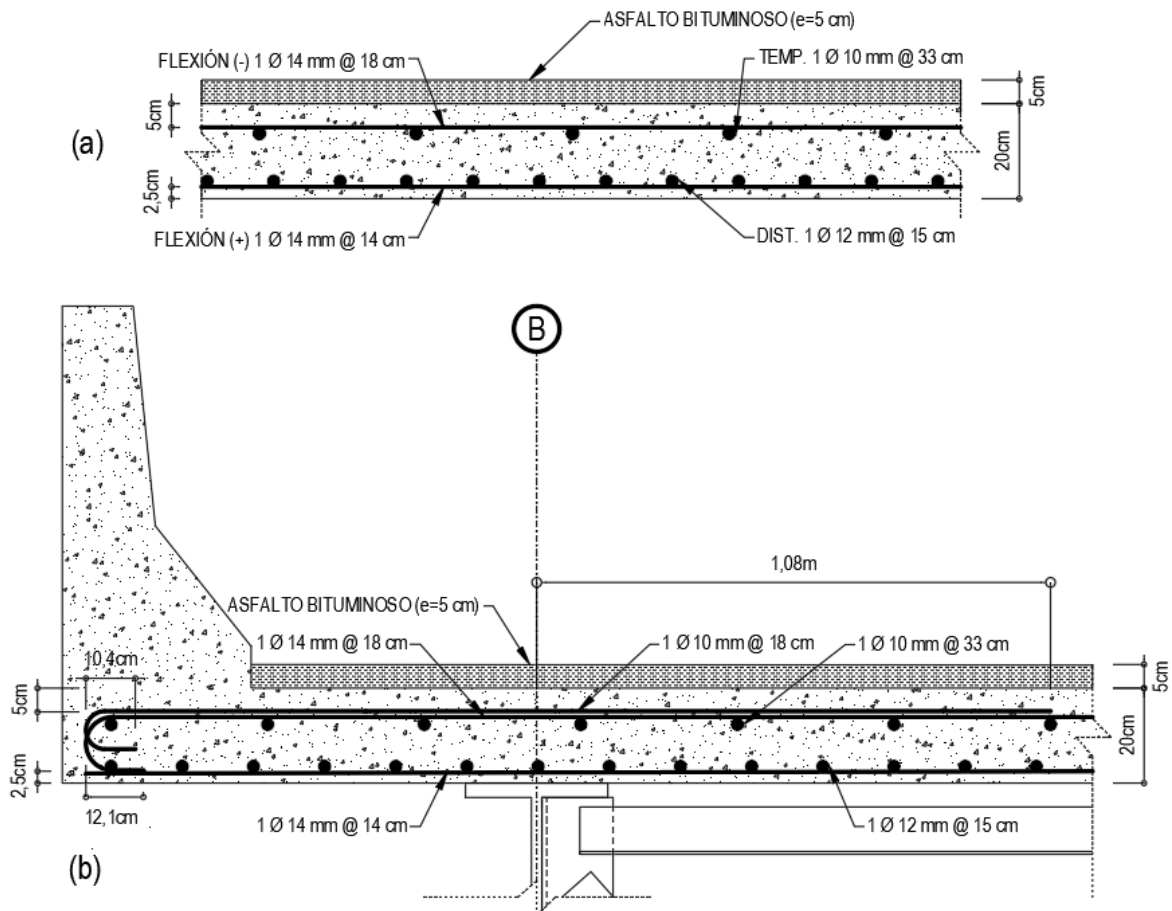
(a) Corte transversal final de la losa y (b) volado variante vigas de acero.
